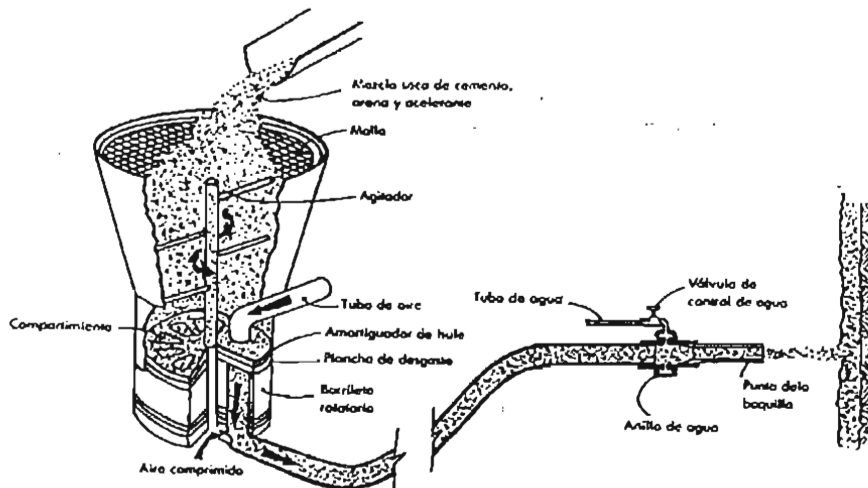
Operación característica de concreto lanzado de mezcla seca.
